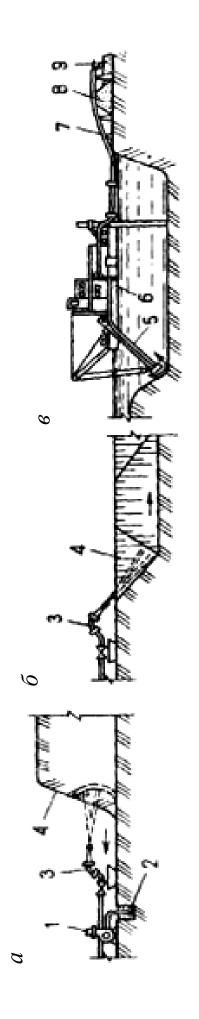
Схема разработки и транспортировки грунта гидромеханическим способом: а — гидромонитором встречным забоем транспортировкой пульпы землесосом; 6 — то же попутным забоем; B — плавучим земснарядом; 1 — землесос; кол (зумпф); 3 — гидромонитор; 4 — забой; 5 — всасывающая труба; 6 — баржа с насосной установкой; 7 — пульпопровод; 8 — грунтовое обвалование; 9 — площадка намыва
